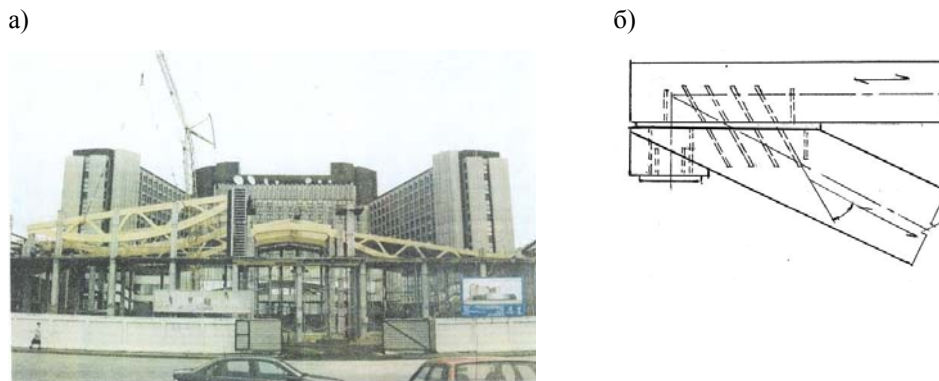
Строительство аквапарка в Санкт-Петербурге (а) и принципиальная схема конструкции опорного узла фермы покрытия (б)
